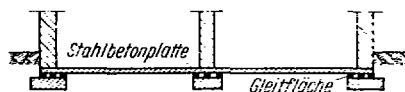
Zerrungssicherung mit durchgehender Stahlbetonplatte
